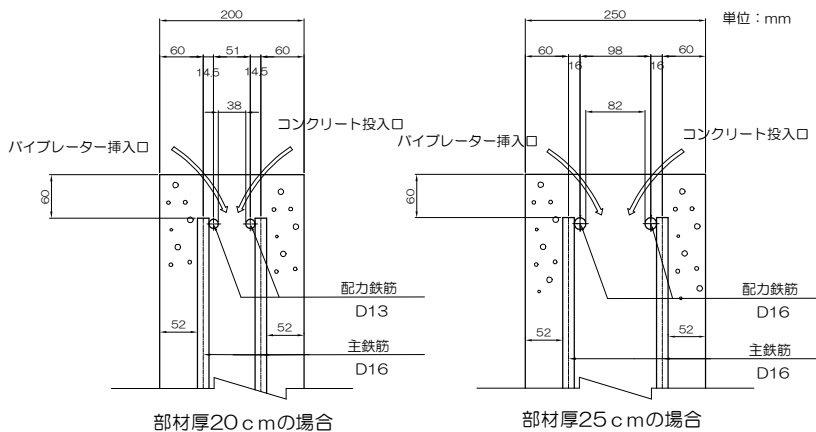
側壁天端の厚さ(複鉄筋構造の施工性比較)
